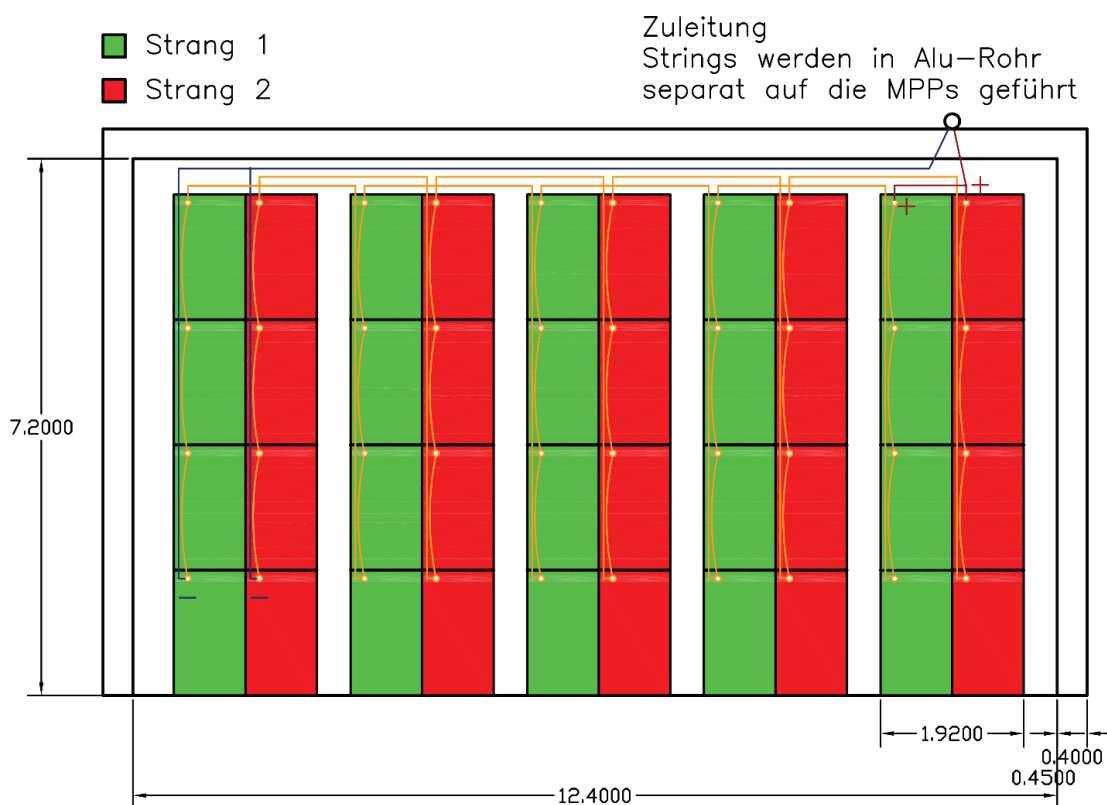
Stringplan der Ost-West Anlage am Standort Waisenhaus
